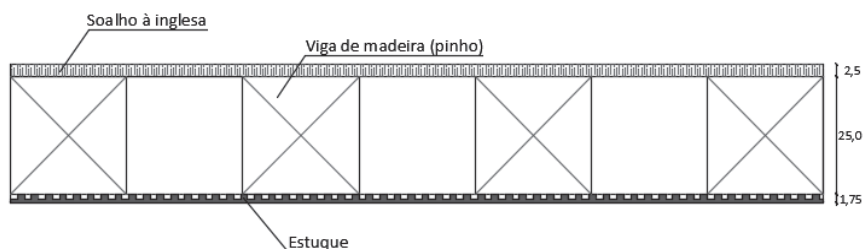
Pavimento piso 1: Corte transversal (cm)
